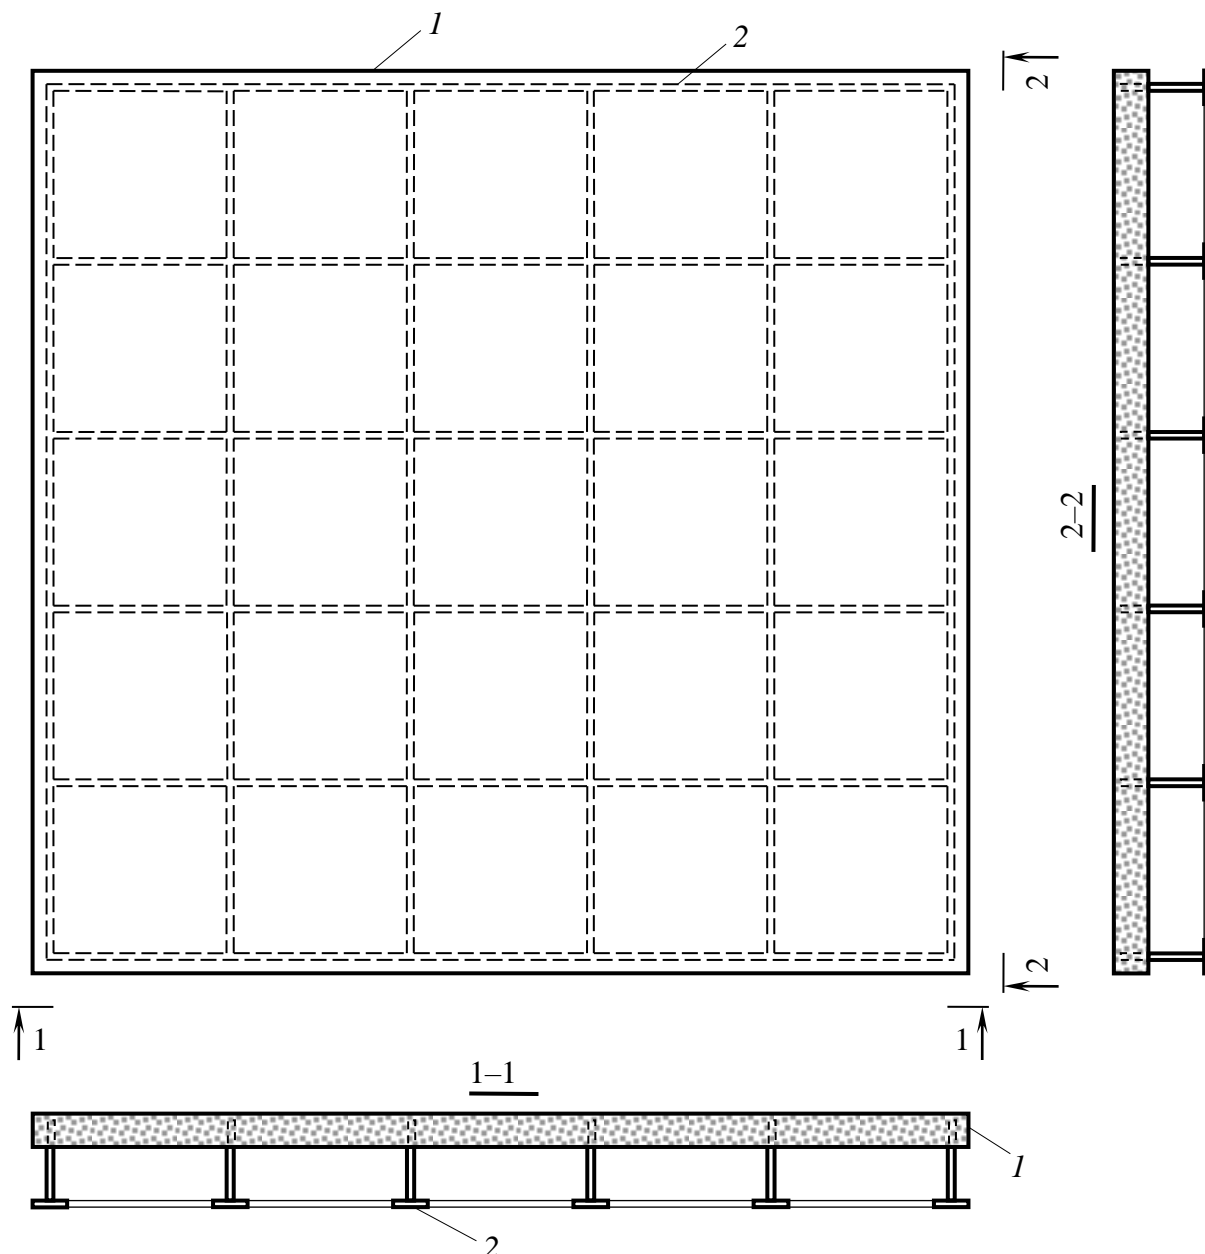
Часторібристе сталезалізобетонне перекриття:
